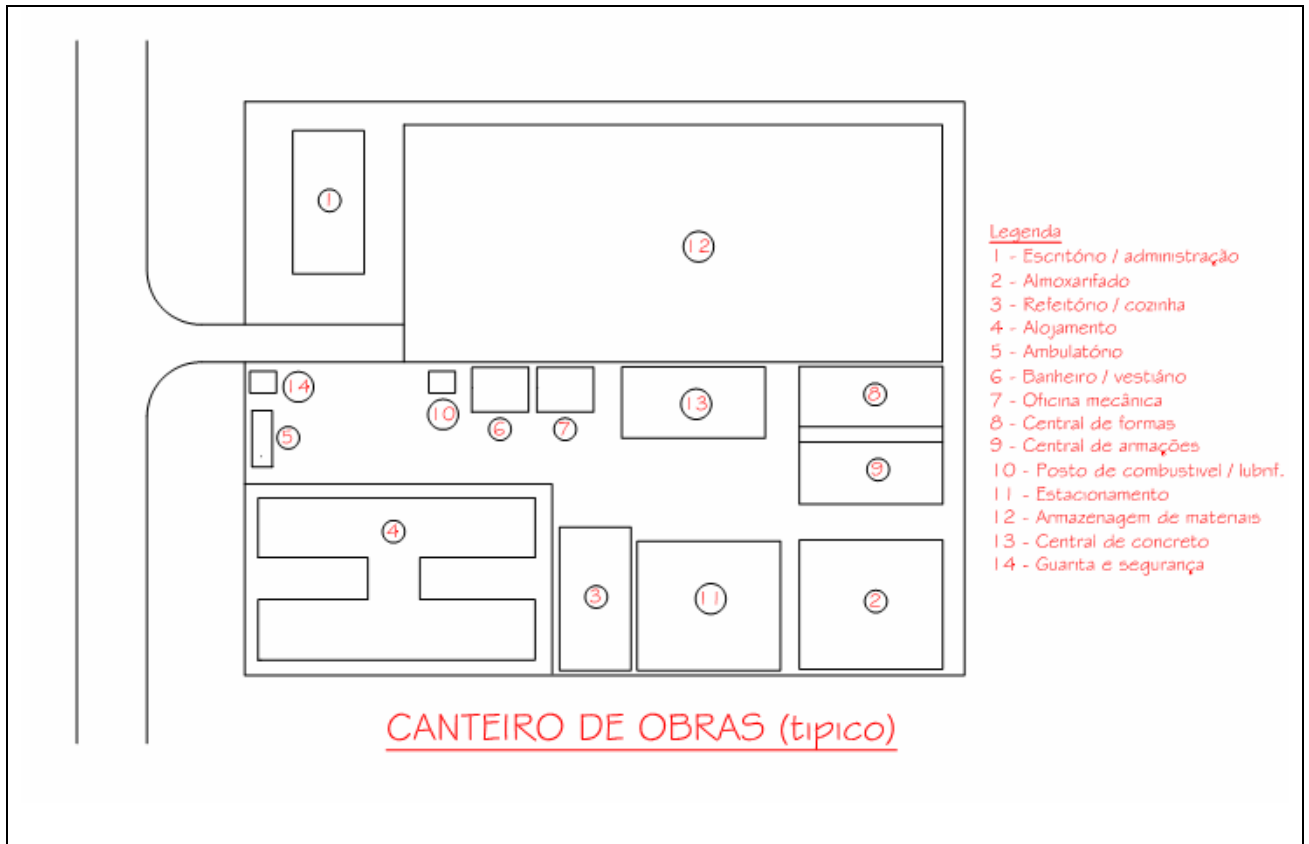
Planta preliminar típica de canteiro de obras (canteiros principais)
